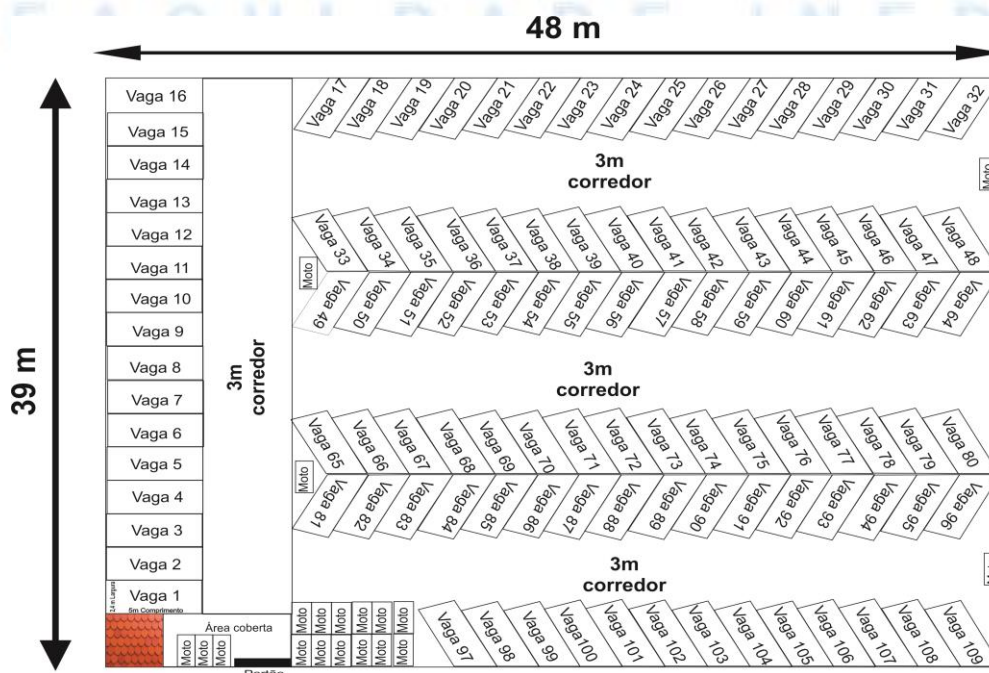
Planta baixa do novo estacionamento da Cesuca.
